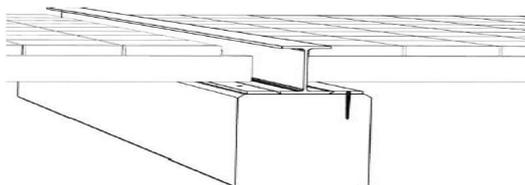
Reforço de viga através da colocação de perfil IPE ou HEA na face superior, conectado mecanicamente com ligadores metálicos que perfuram apenas parte da viga (Mariani, 2004)
